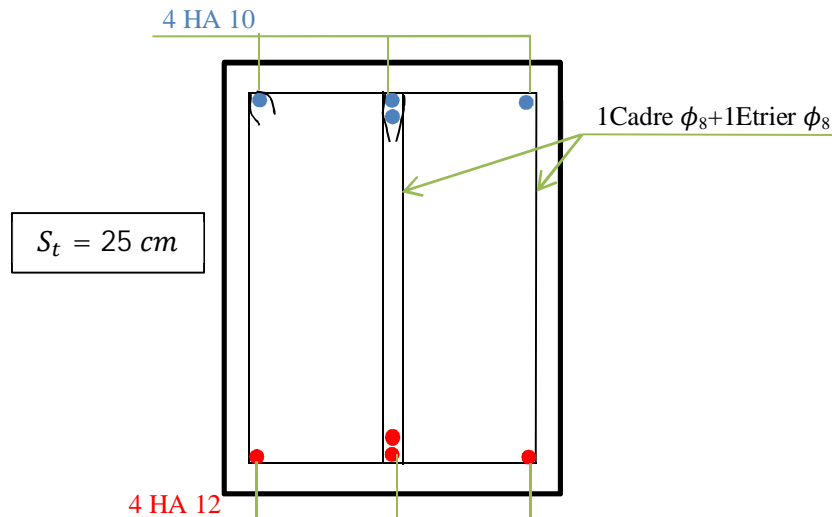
Schéma de ferrailage de la poutre de chaînage
